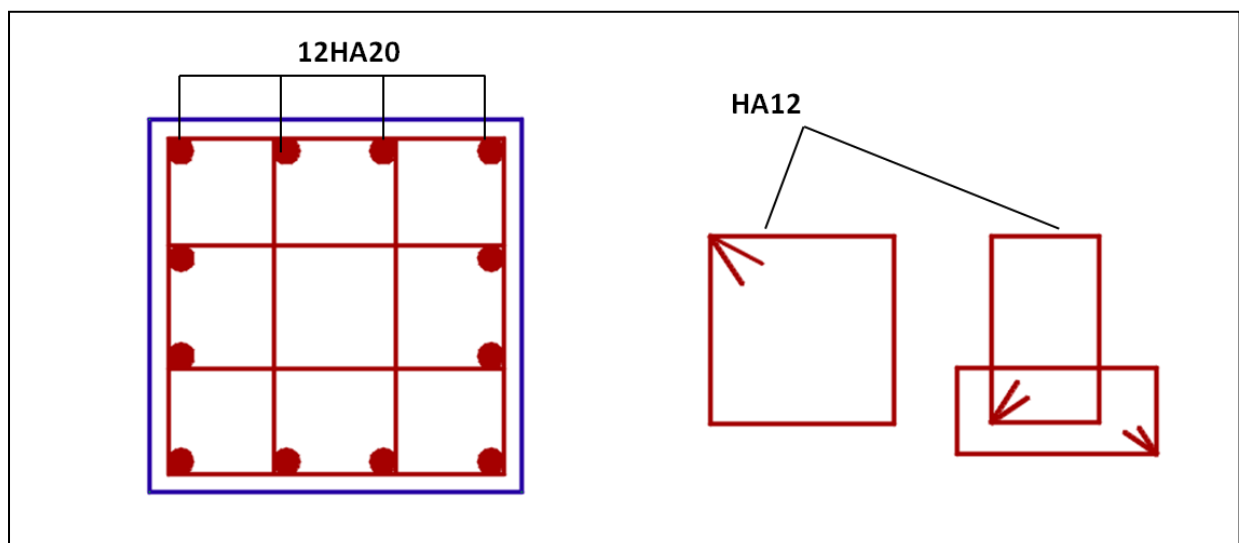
Schéma de ferrailage du poteau 60x60
